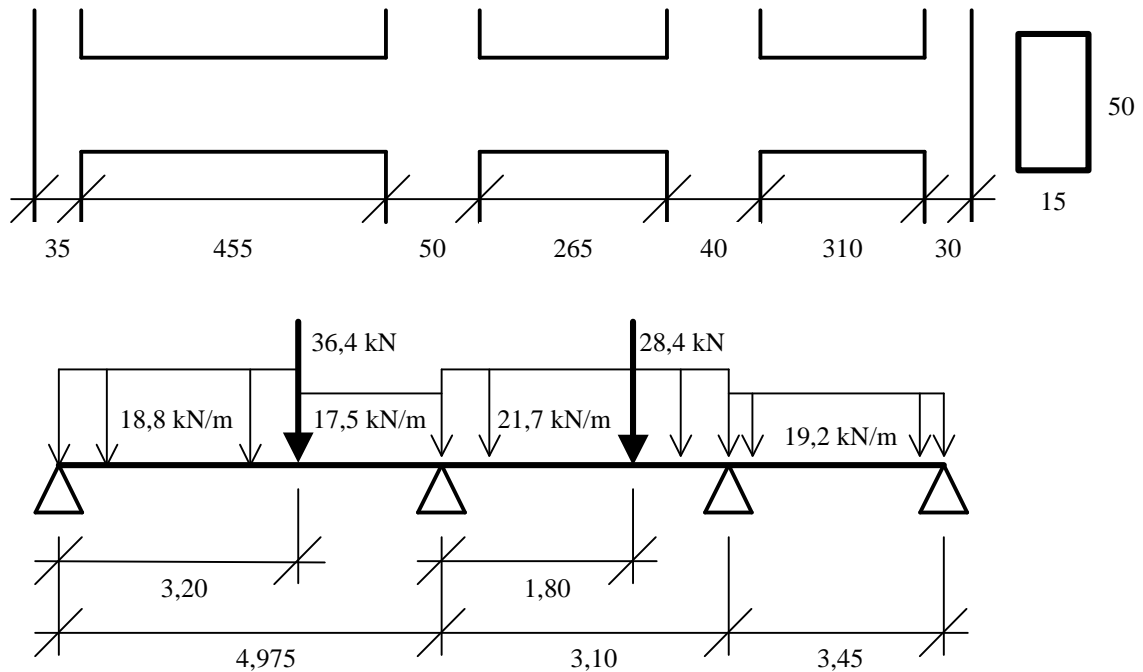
Dimensões e Carregamentos da Viga do Exemplo 4.
